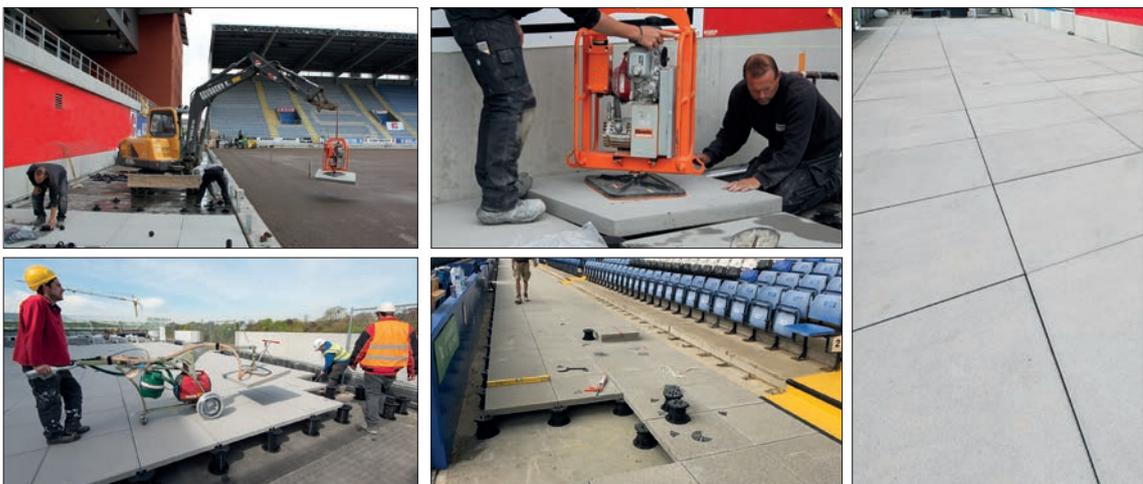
Exemples de pose de dalles de grand format ou de dalles préfabriquées en béton sur des plots
